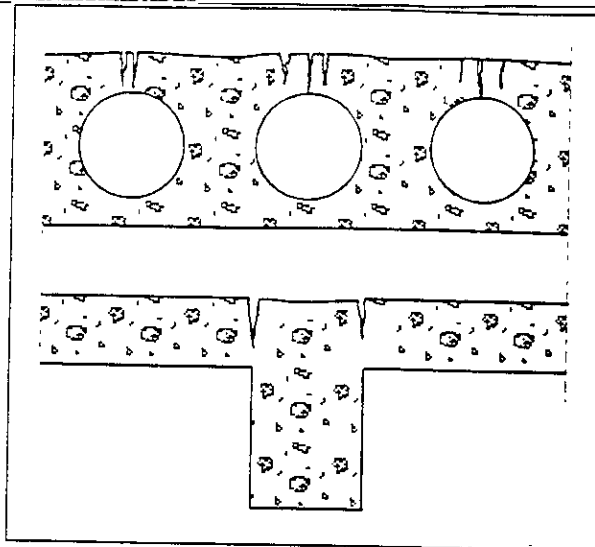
Asentamiento plástico en losas con vacíos y losa sobre travesaños
